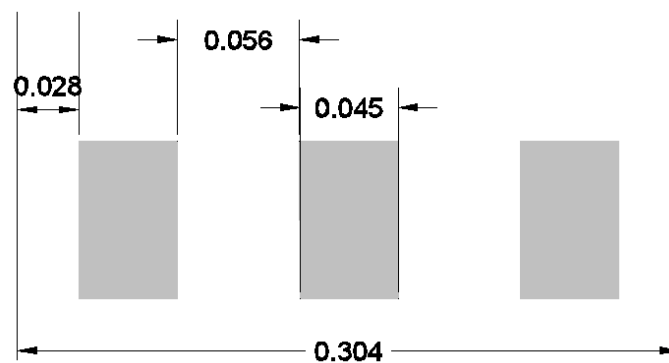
Planta de la fila de bloques tipo Ranga Raju
